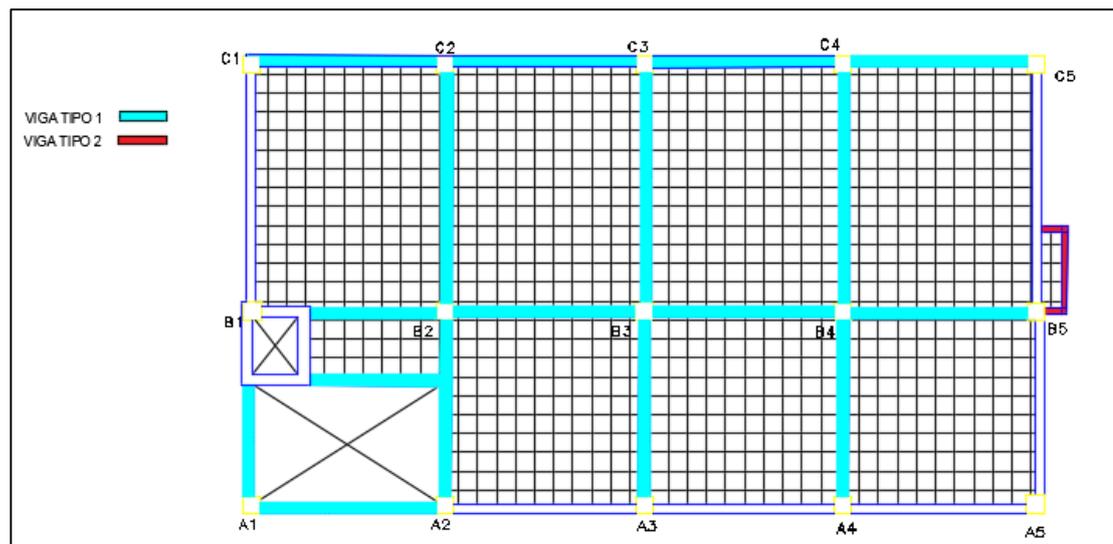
Esquema de distribución de vigas tipo N+1,62 (Hormigón)
